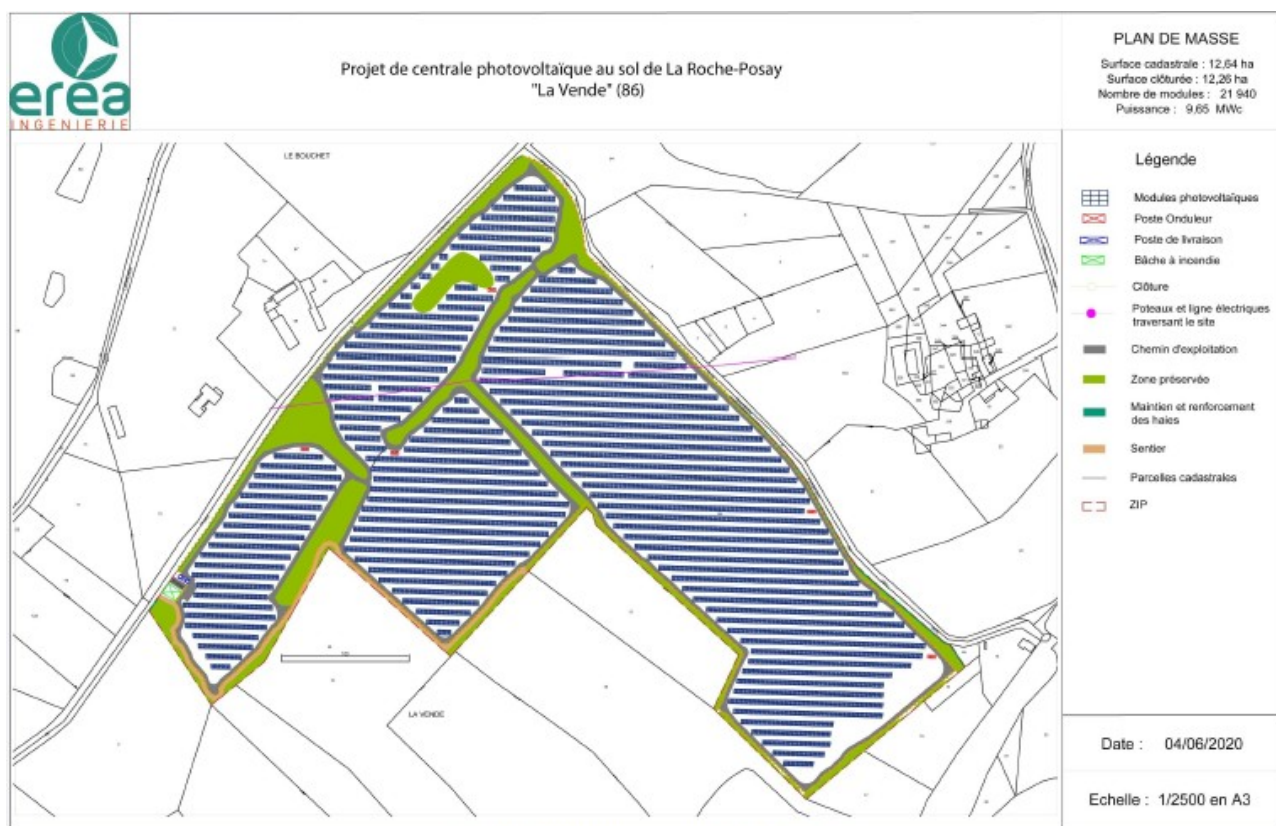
Plan de masse (Source : EREA INGENIERIE - Juin 2020)
